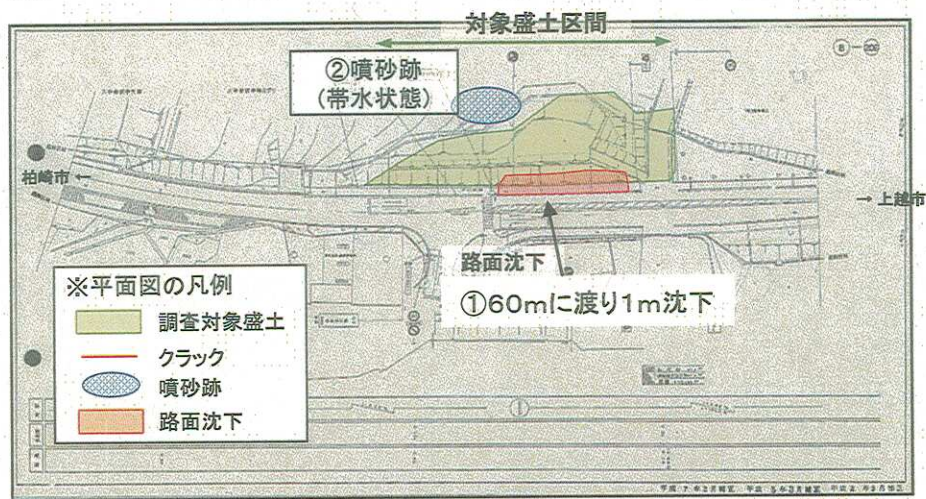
被災盛土の平面図(国道8号36.9kp 柏崎市鯨波地先)
